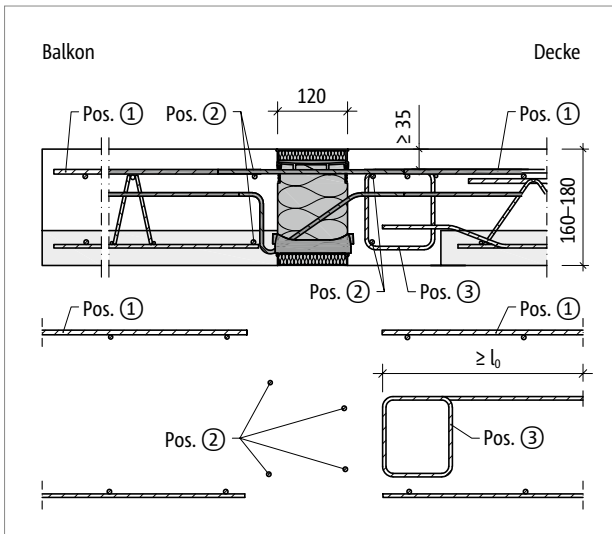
Schöck Isokorb® XT Typ KL-F: Bauseitige Bewehrung bei Balkonplattendicke  $h = 160\text{--}180\text{ mm}$
